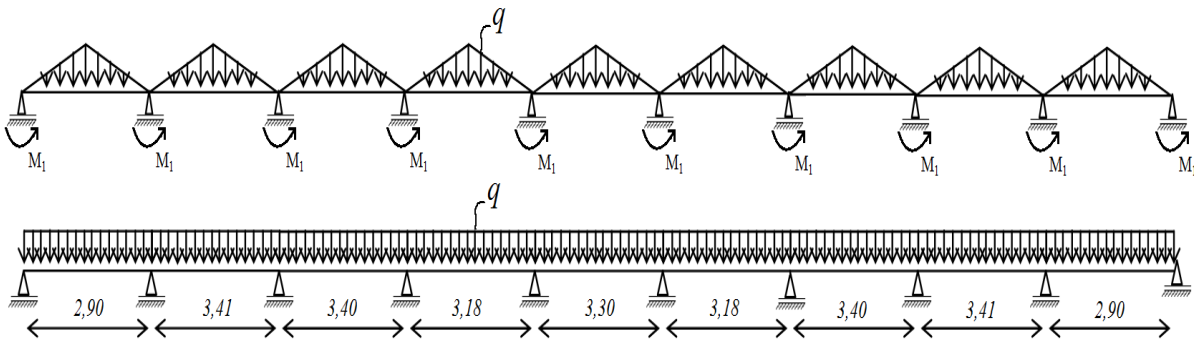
Schéma statique de la poutre secondaire.
